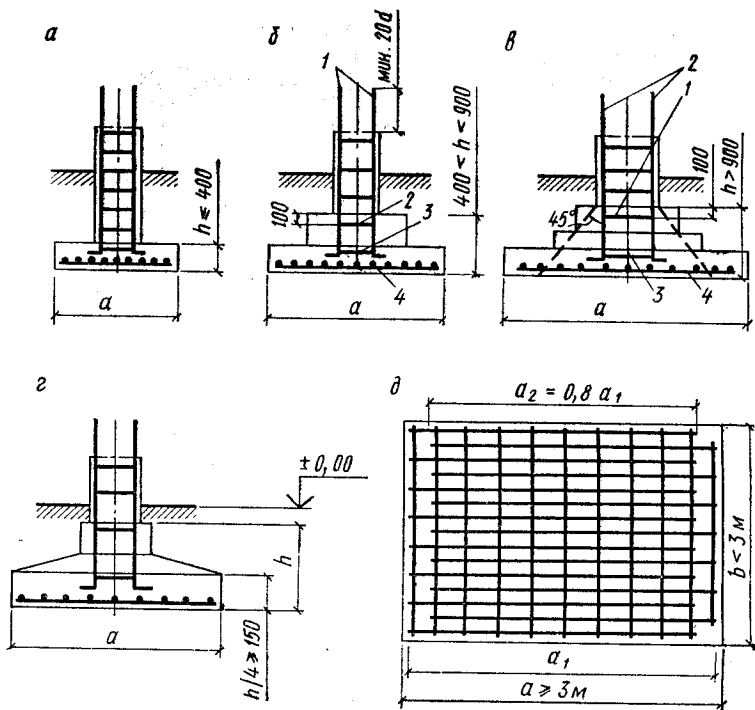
Монолитные железобетонные отдельные фундаменты
